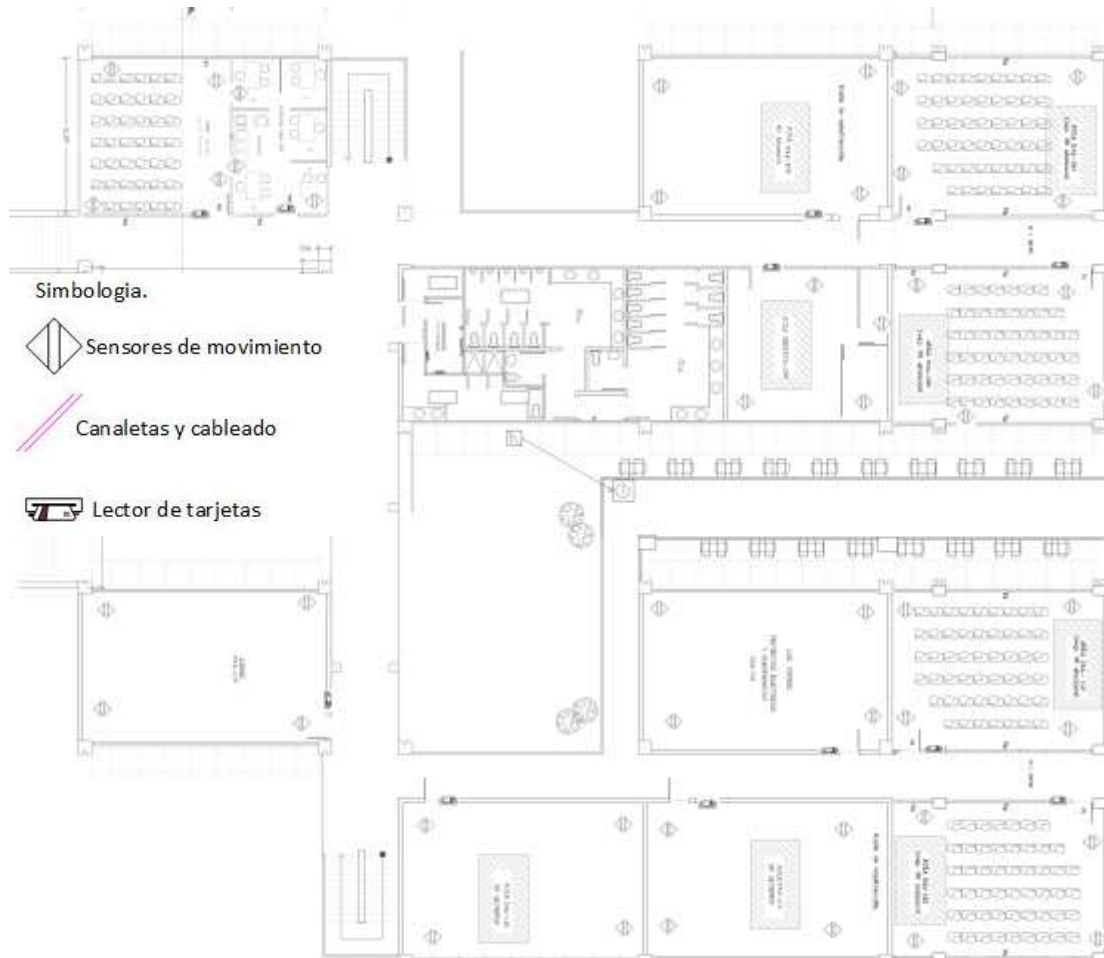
Diseño Estructural del Sistema del bloque 24A y B planta baja
